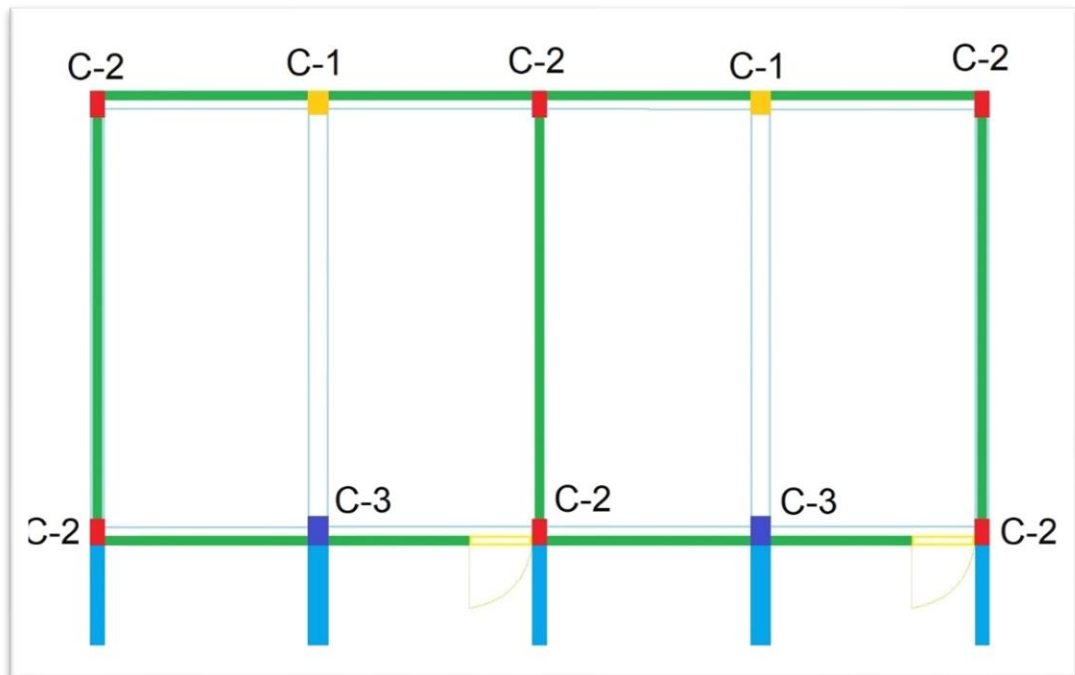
Distribución de columnas del pabellón 11 – bloque A.
